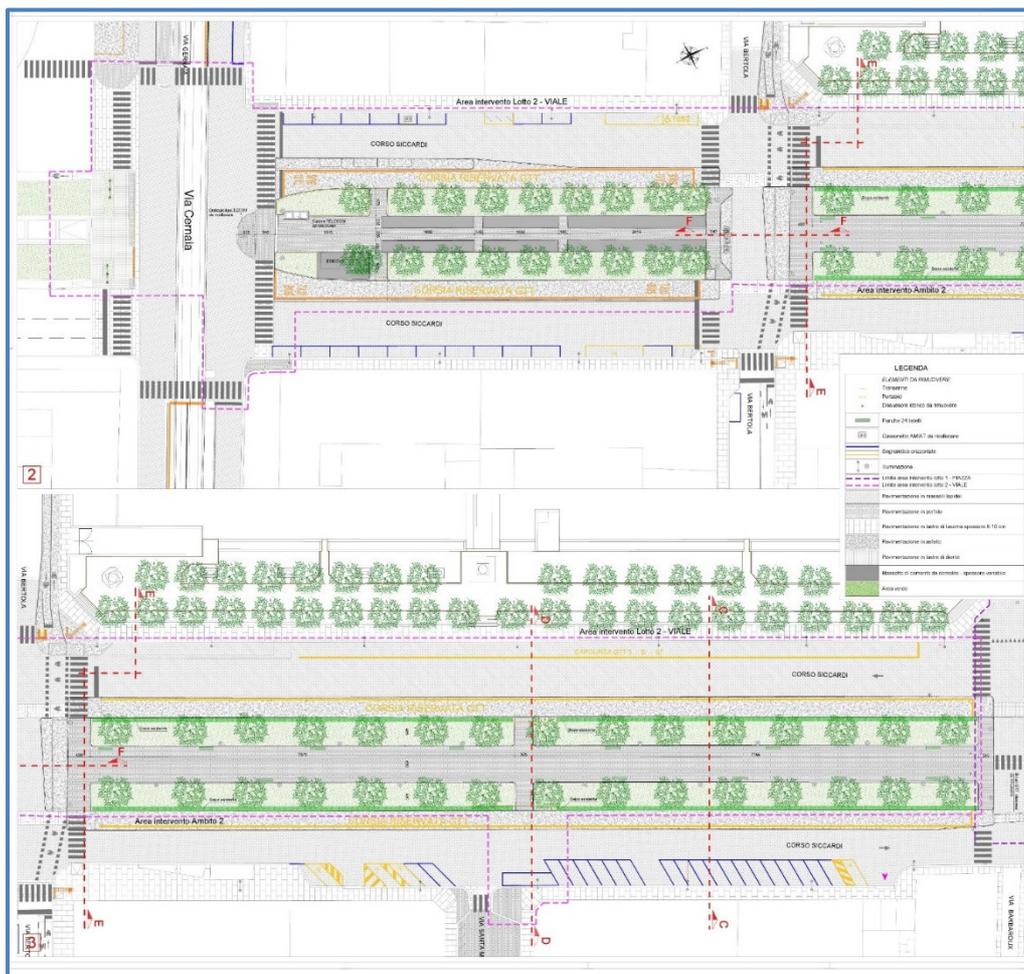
Lotto 2 Viale Planimetria stato di fatto
